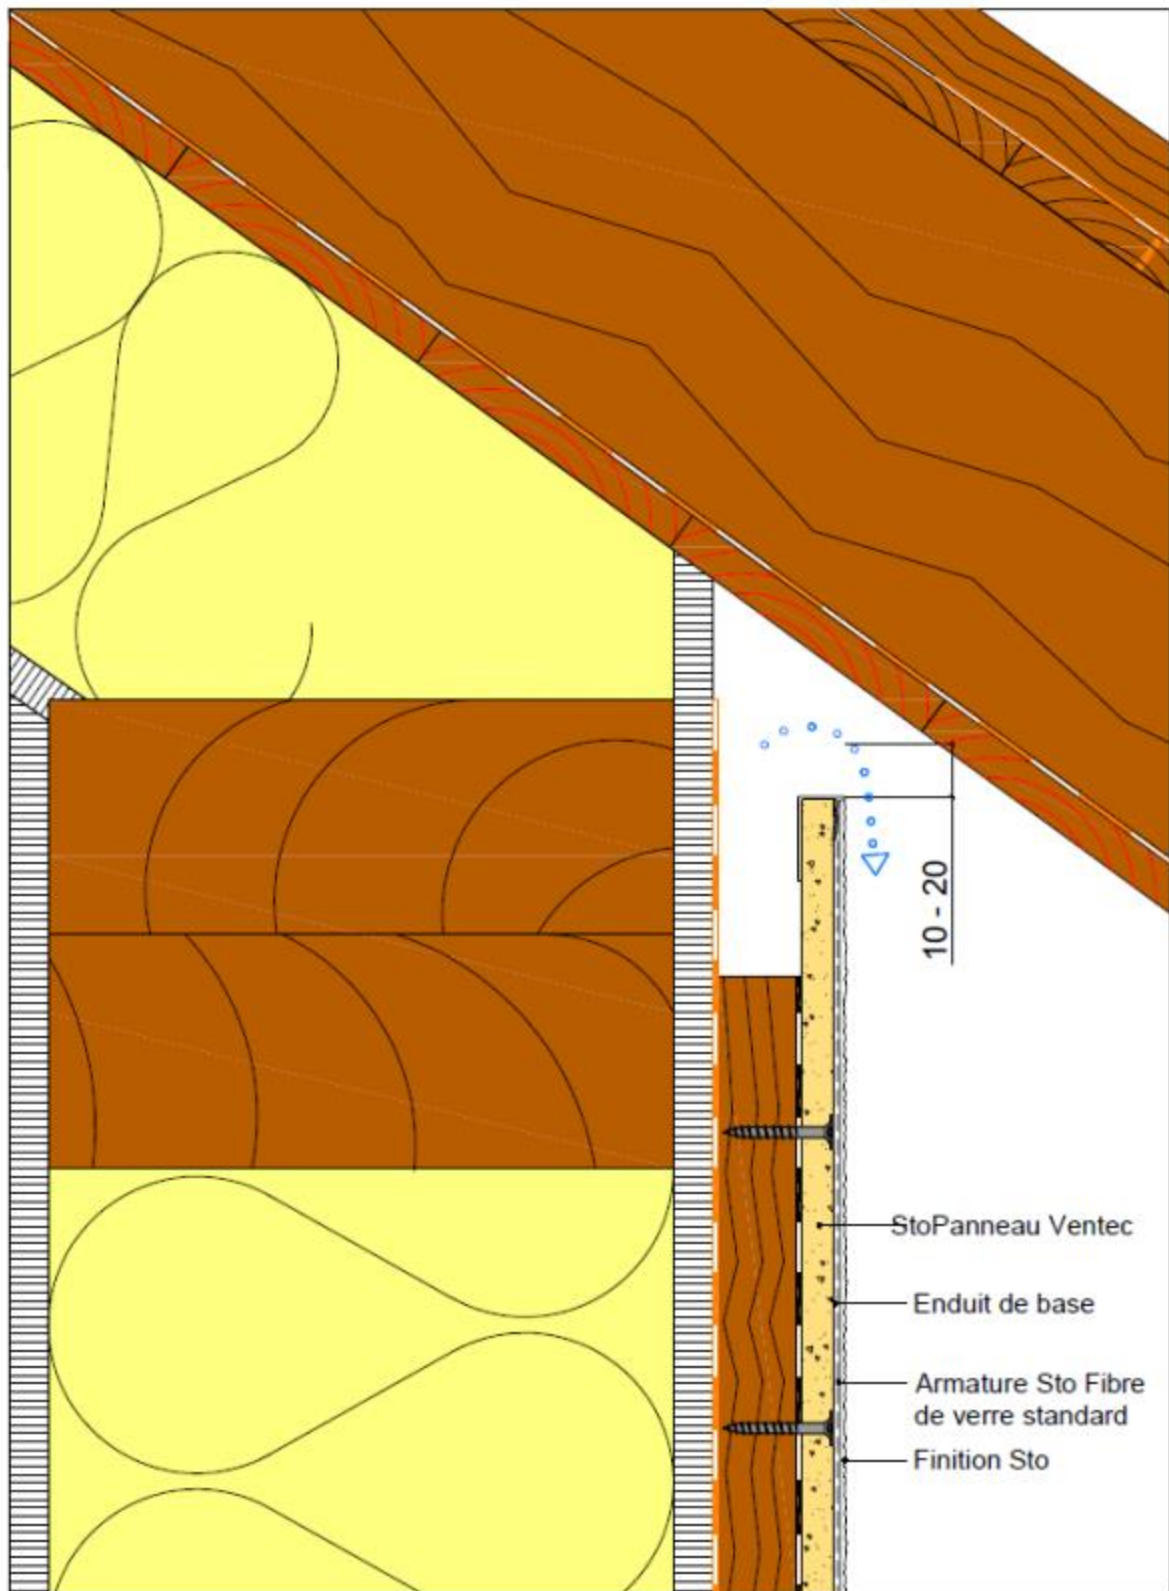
Coupe verticale - Acrotère et sous-face de toiture - Ossatures bois sur COB
